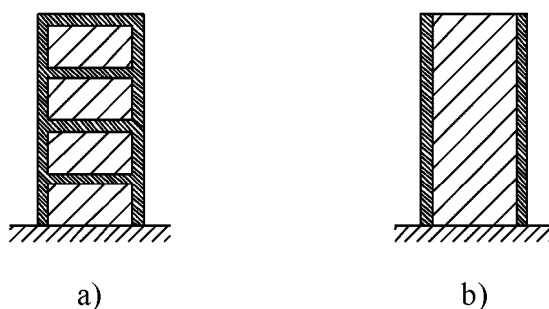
Sistemas estructurales mixtos. Muros mixtos:
